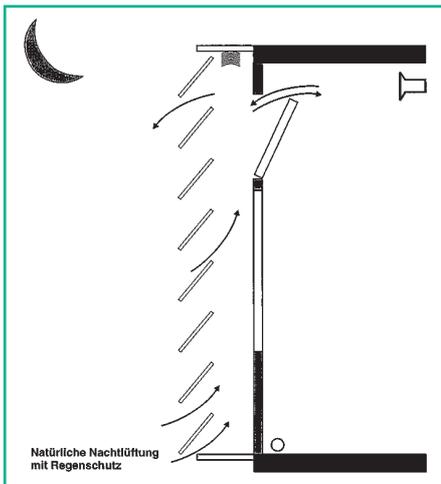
Funktionsschema Glas-Doppelfassade – Nachtabkühlung im Sommer
